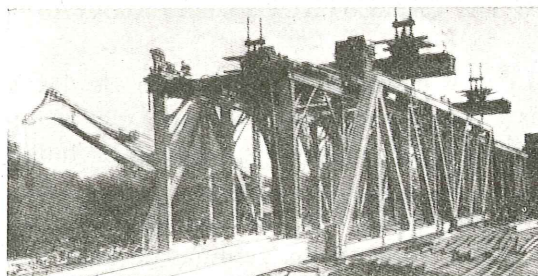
Puente Victoria, en el ferrocarril del noroeste de la India. Vigas en celosía, de 46,5 m de luz, con pretensado de los montantes para reducir las deformaciones secundarias bajo sobrecarga total.
